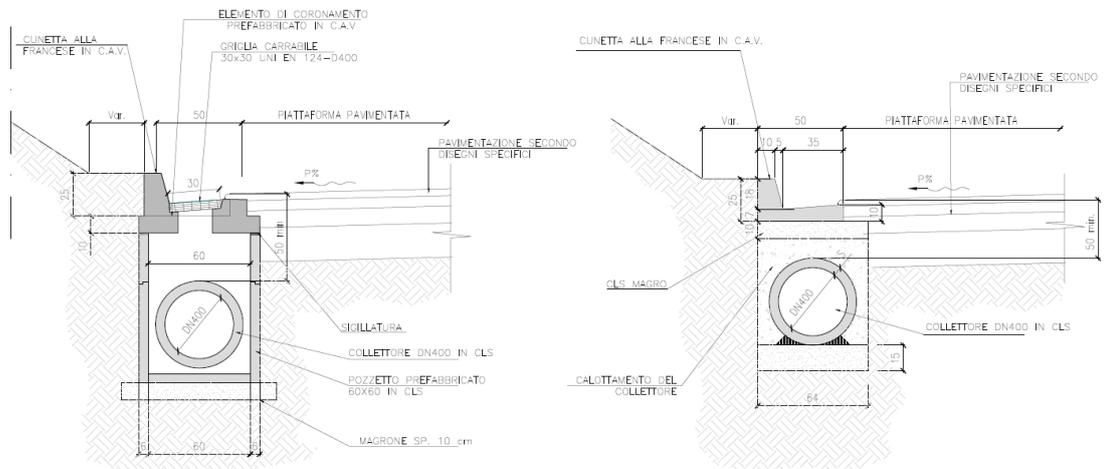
Sezione tipo pozzetto di raccolta (a sinistra) e sezione tipo cunetta (a destra) lungo Asse "A".
